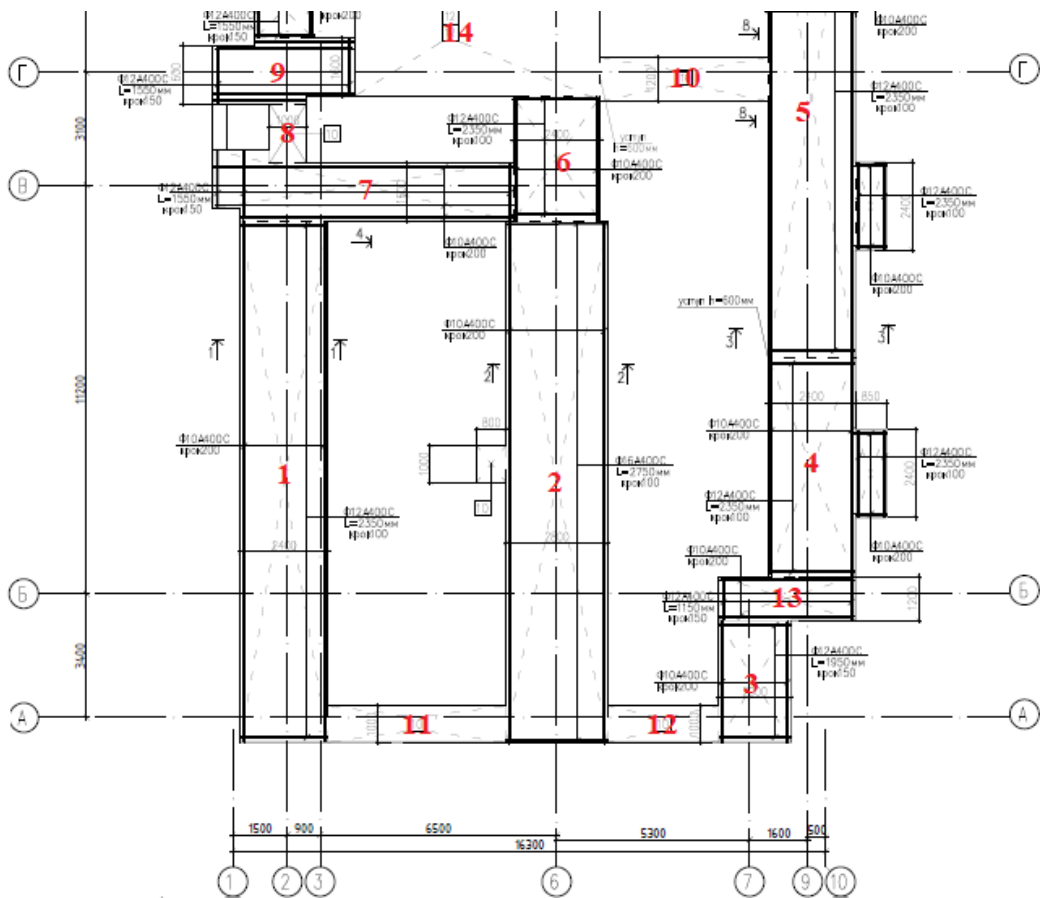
(продовження) – Нумерація фундаментних подушок для армування
